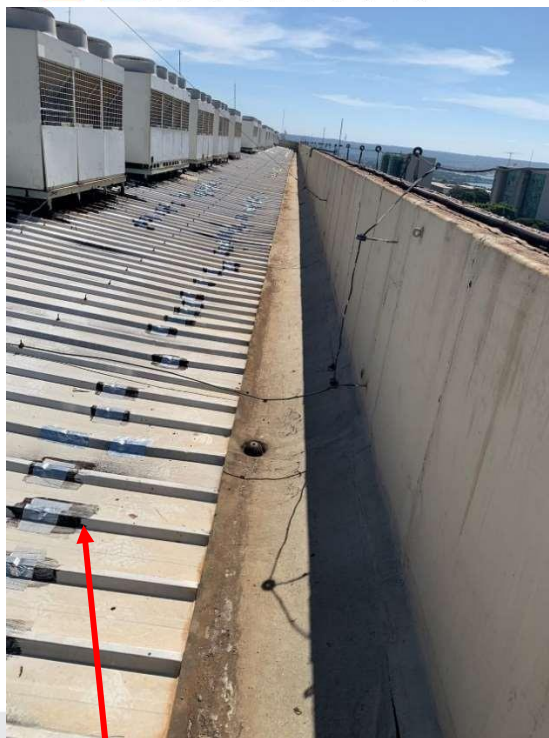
Telhado danificado em função da manutenção das máquinas frigorígenas
